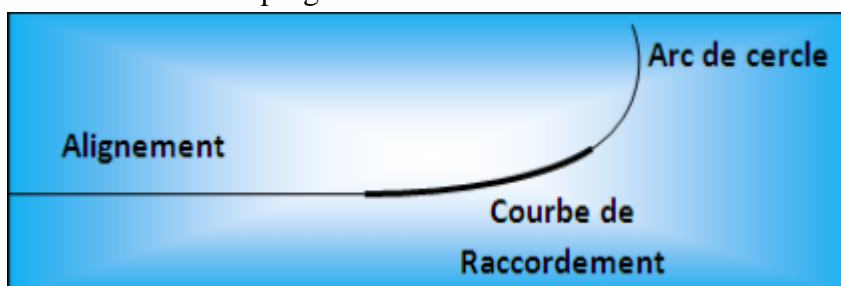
Schéma explicatif sur les éléments de tracé en plan
